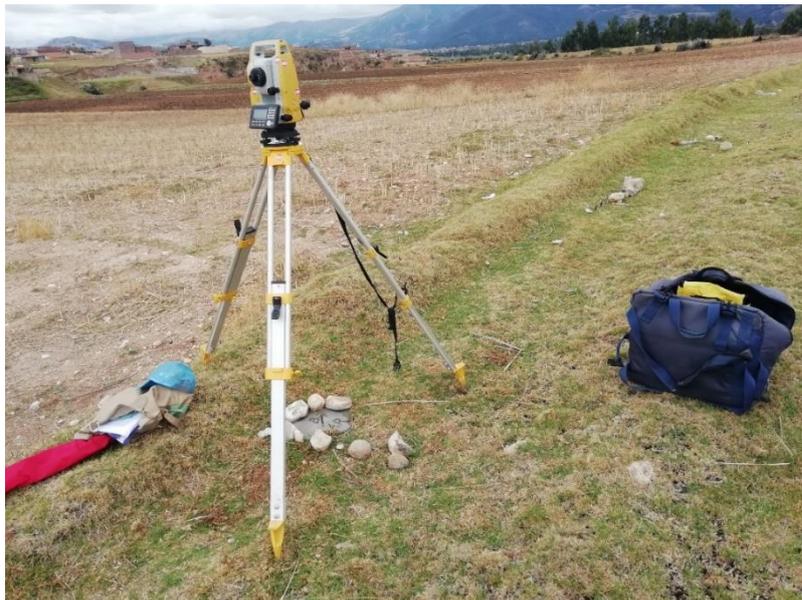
Instrumentos utilizados para el levantamiento topográfico de zona propuesta.
